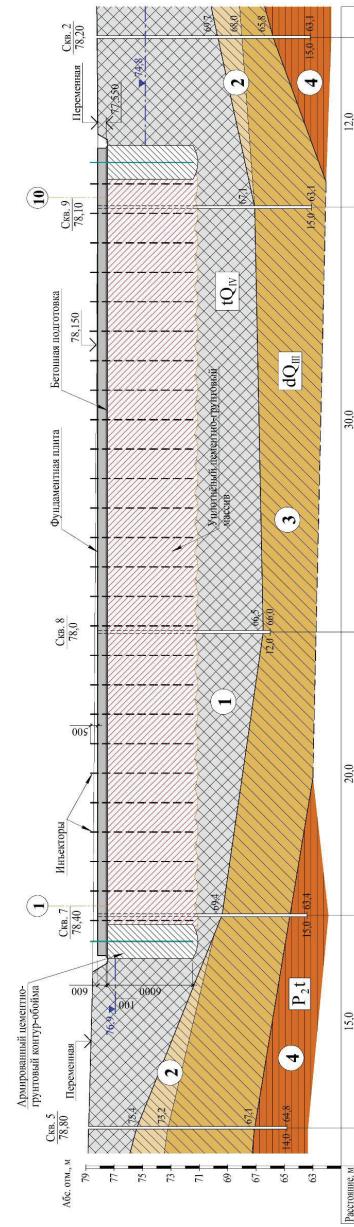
Монолитная железобетонная фундаментная плита на цементно-грунтовом основании. Размер 2-2
